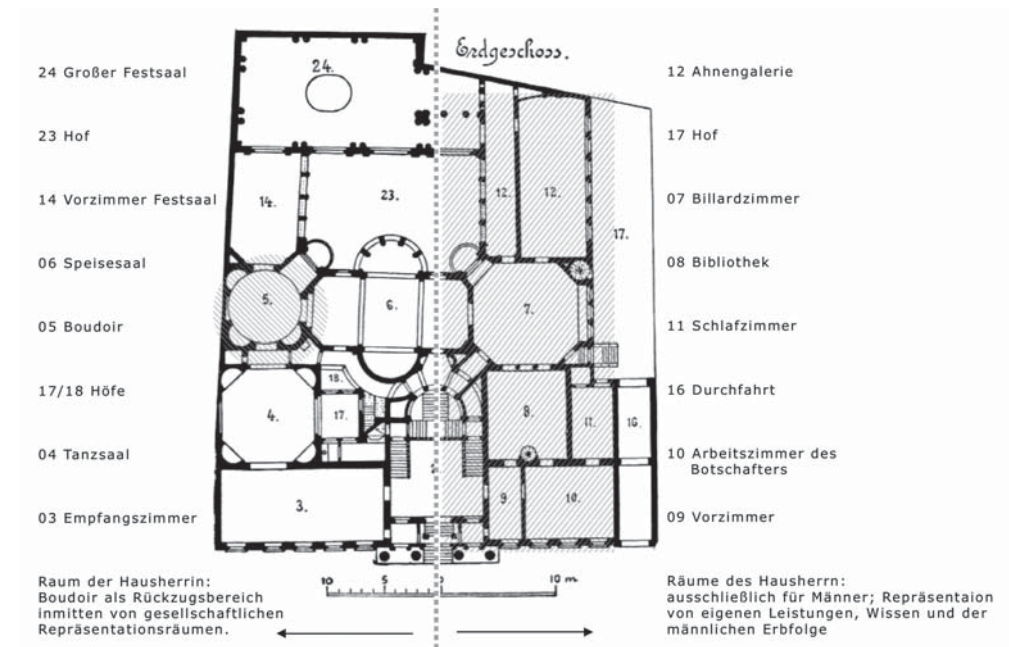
geschlechtsspezifisches Grundrisschema Palais Strousberg.
